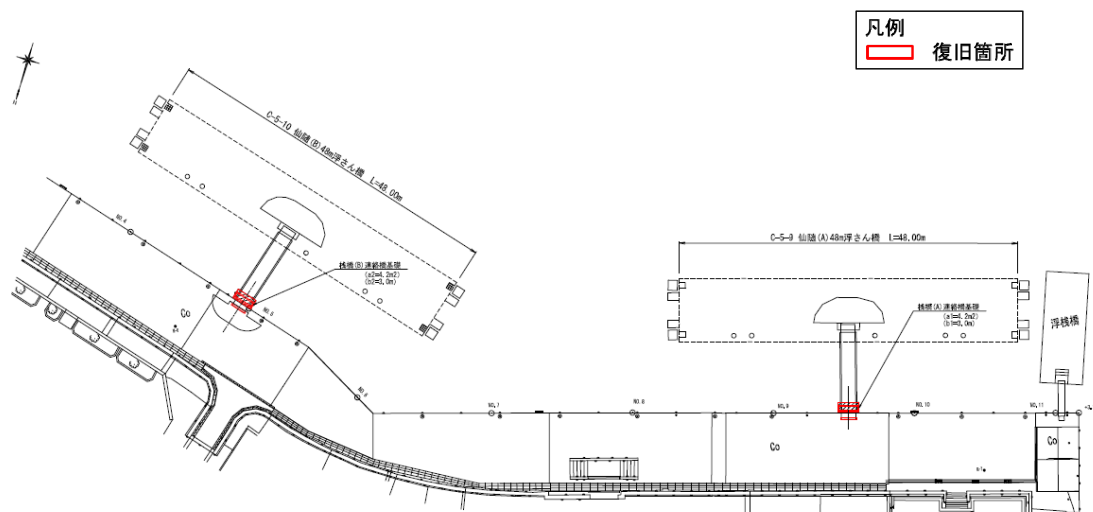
16 No.2 仙髓(A)(B)浮棧橋の平面図（復旧後）
